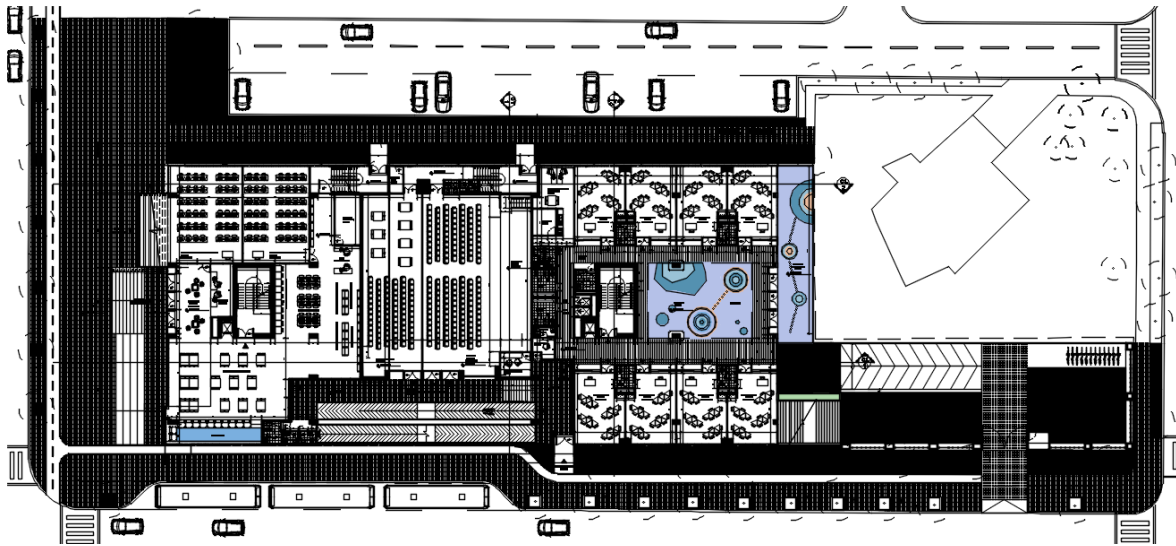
Planta Arquitectónica Nivel 0.0
